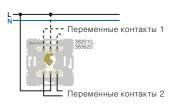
Выключатель/переключатель 1- и 2-полюсный для профильных полуцилиндров [№ для заказа 3826 10, 3836 20]
